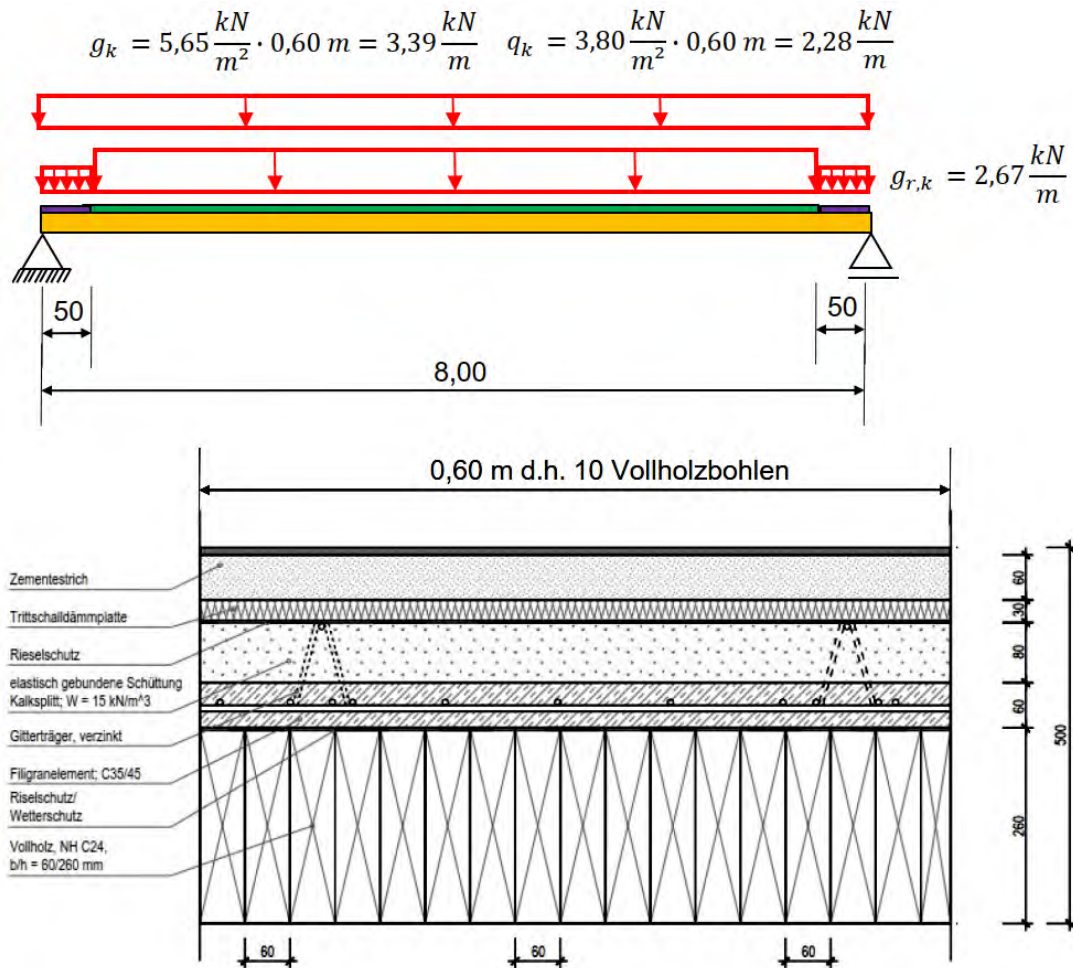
Oben: Statisches System für eine rückbaubare Holz-Beton-Verbunddecke mit 8,0m Spannweite. Unten: Deckenaufbau der rückbaubaren Holz-Beton-Verbunddecke bei einer Elementbreite von  $b = 0,60m$ .
